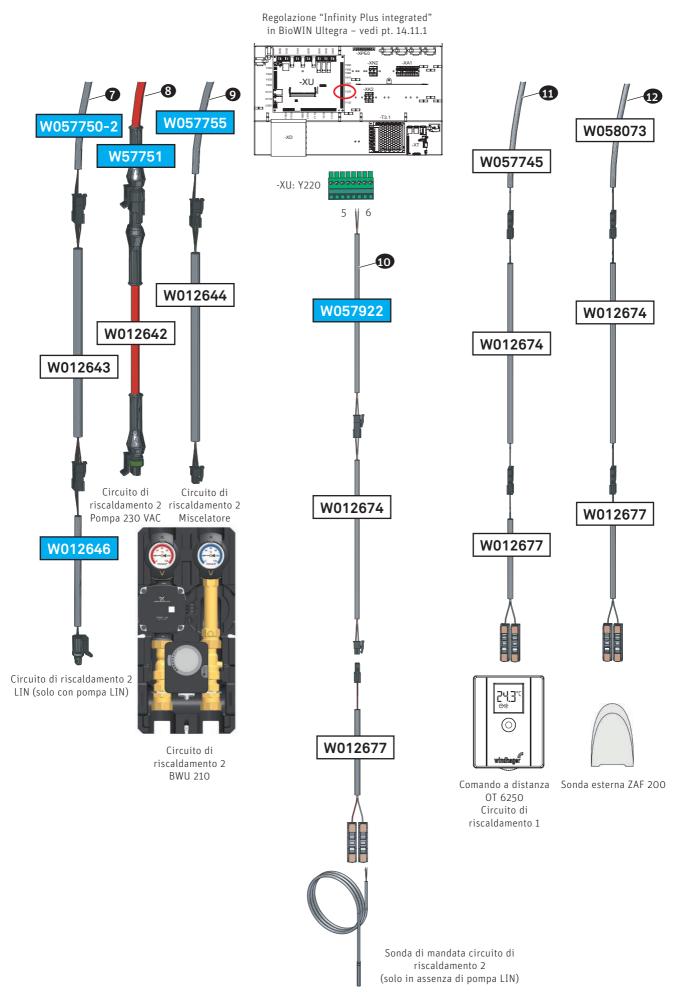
Collegamenti a spina sul retro della caldaia a pellet
